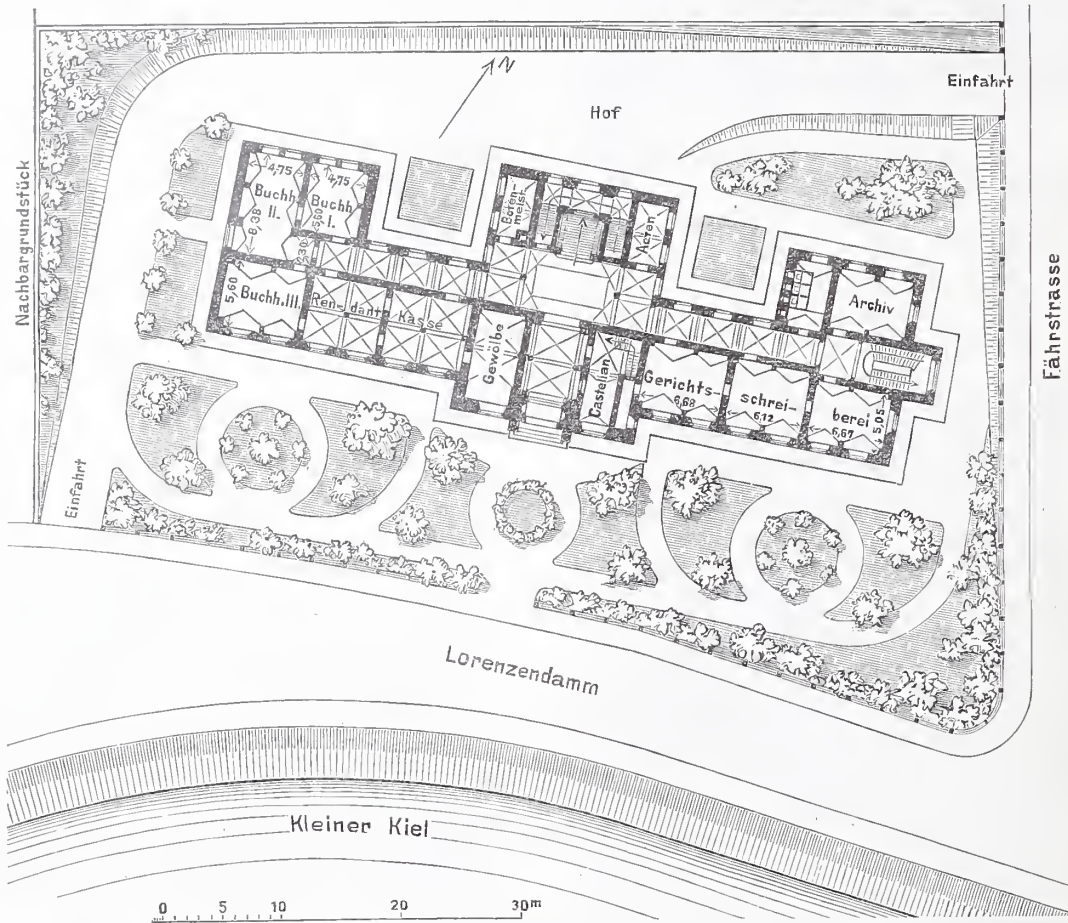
Lageplan mit Erdgeschossgrundriss.
